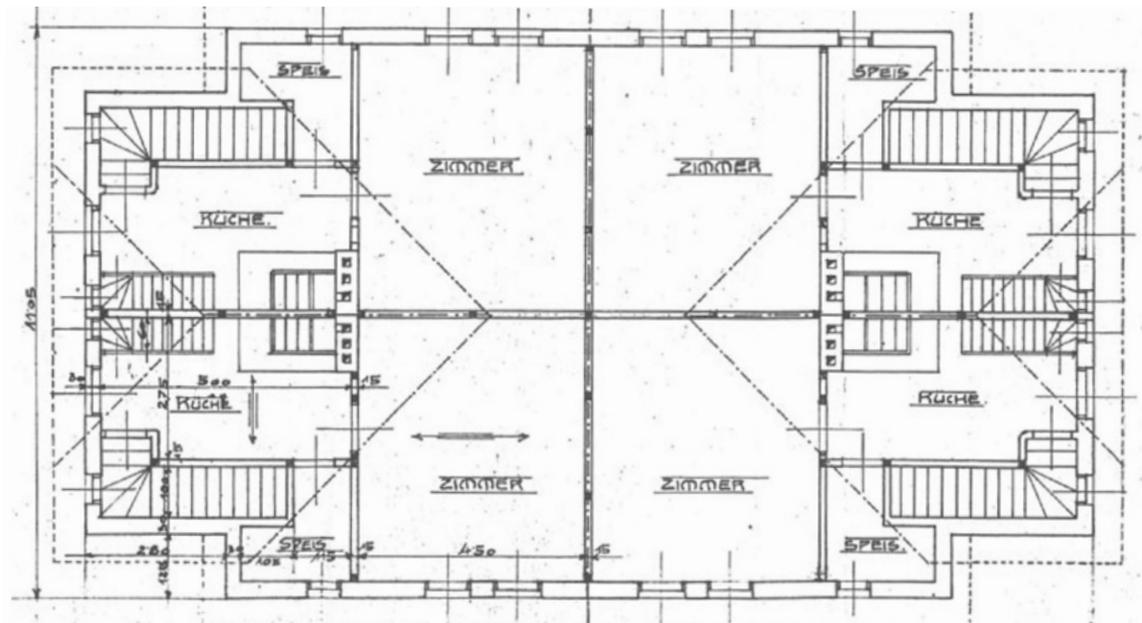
| Grundriss Soutterain und Dachgeschoß
